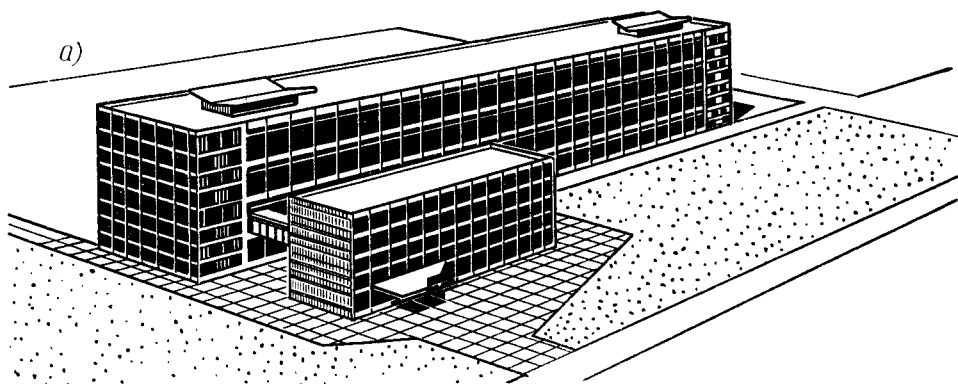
Герметизированные здания с отдельно стоящими бытовыми помещениями:
